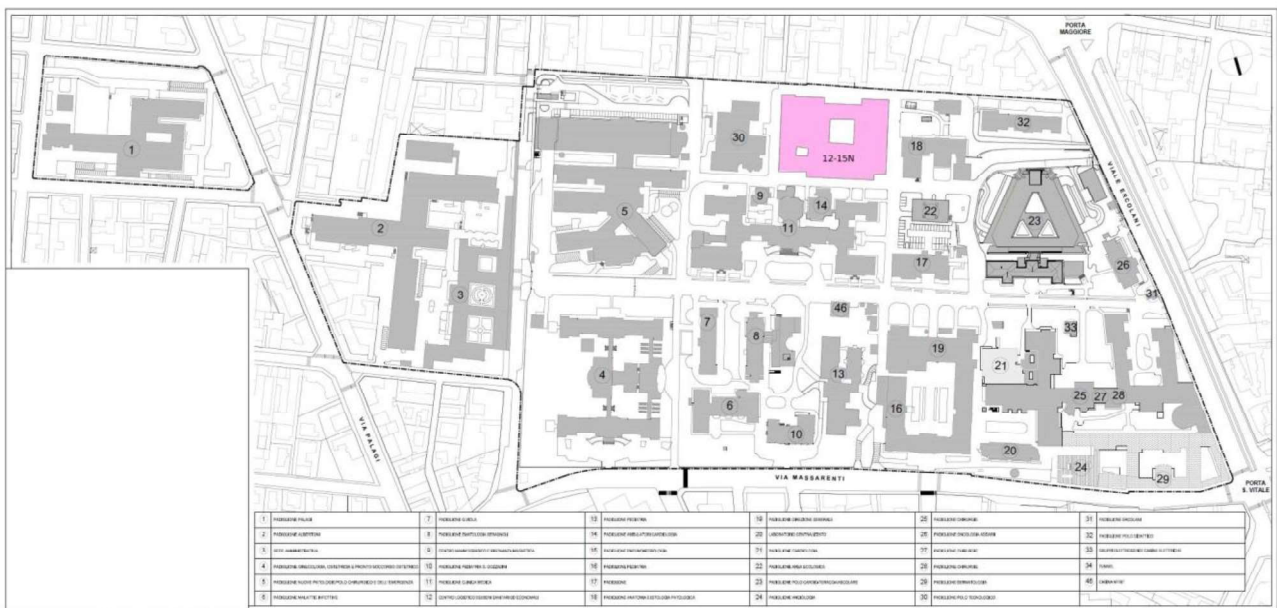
Planimetria generale con collocazione del nuovo complesso 12-15N nel comprensorio
